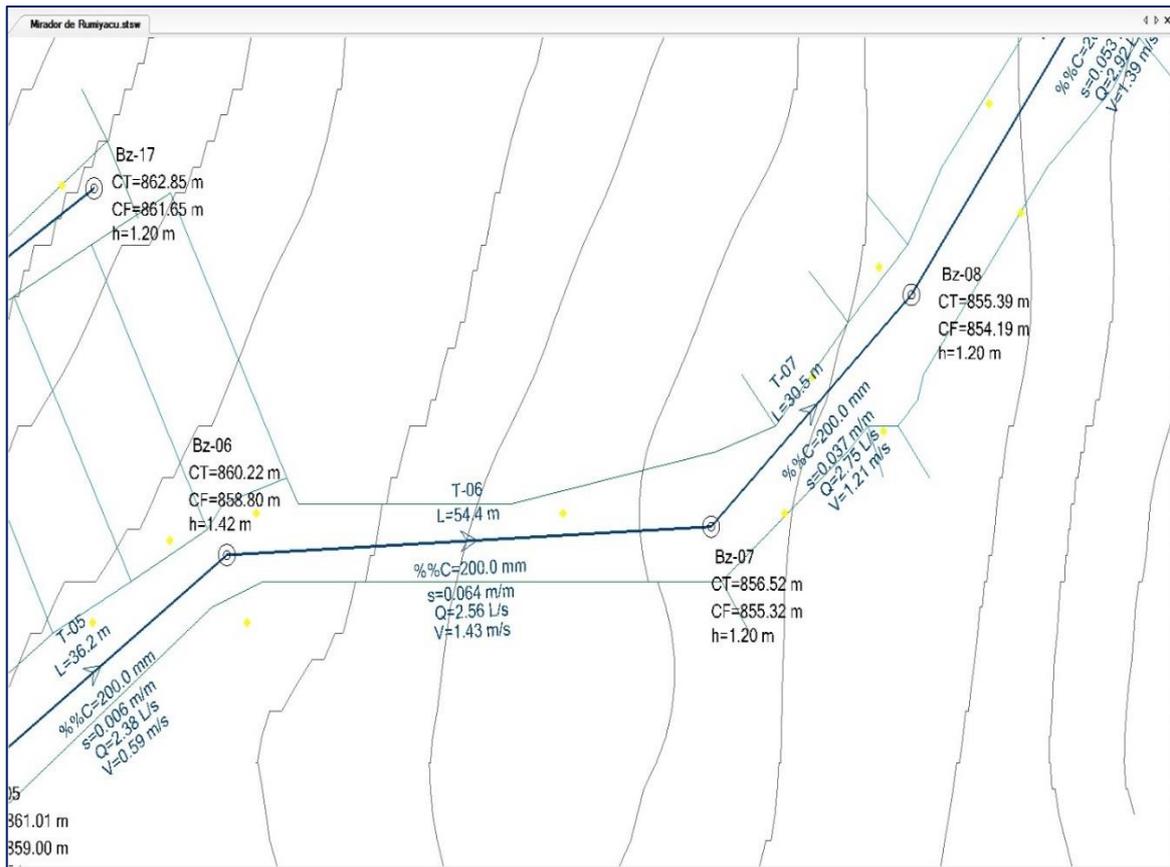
Vista de planta del buzón 06 al 08. (Fuente: Software SEWERCAD).
